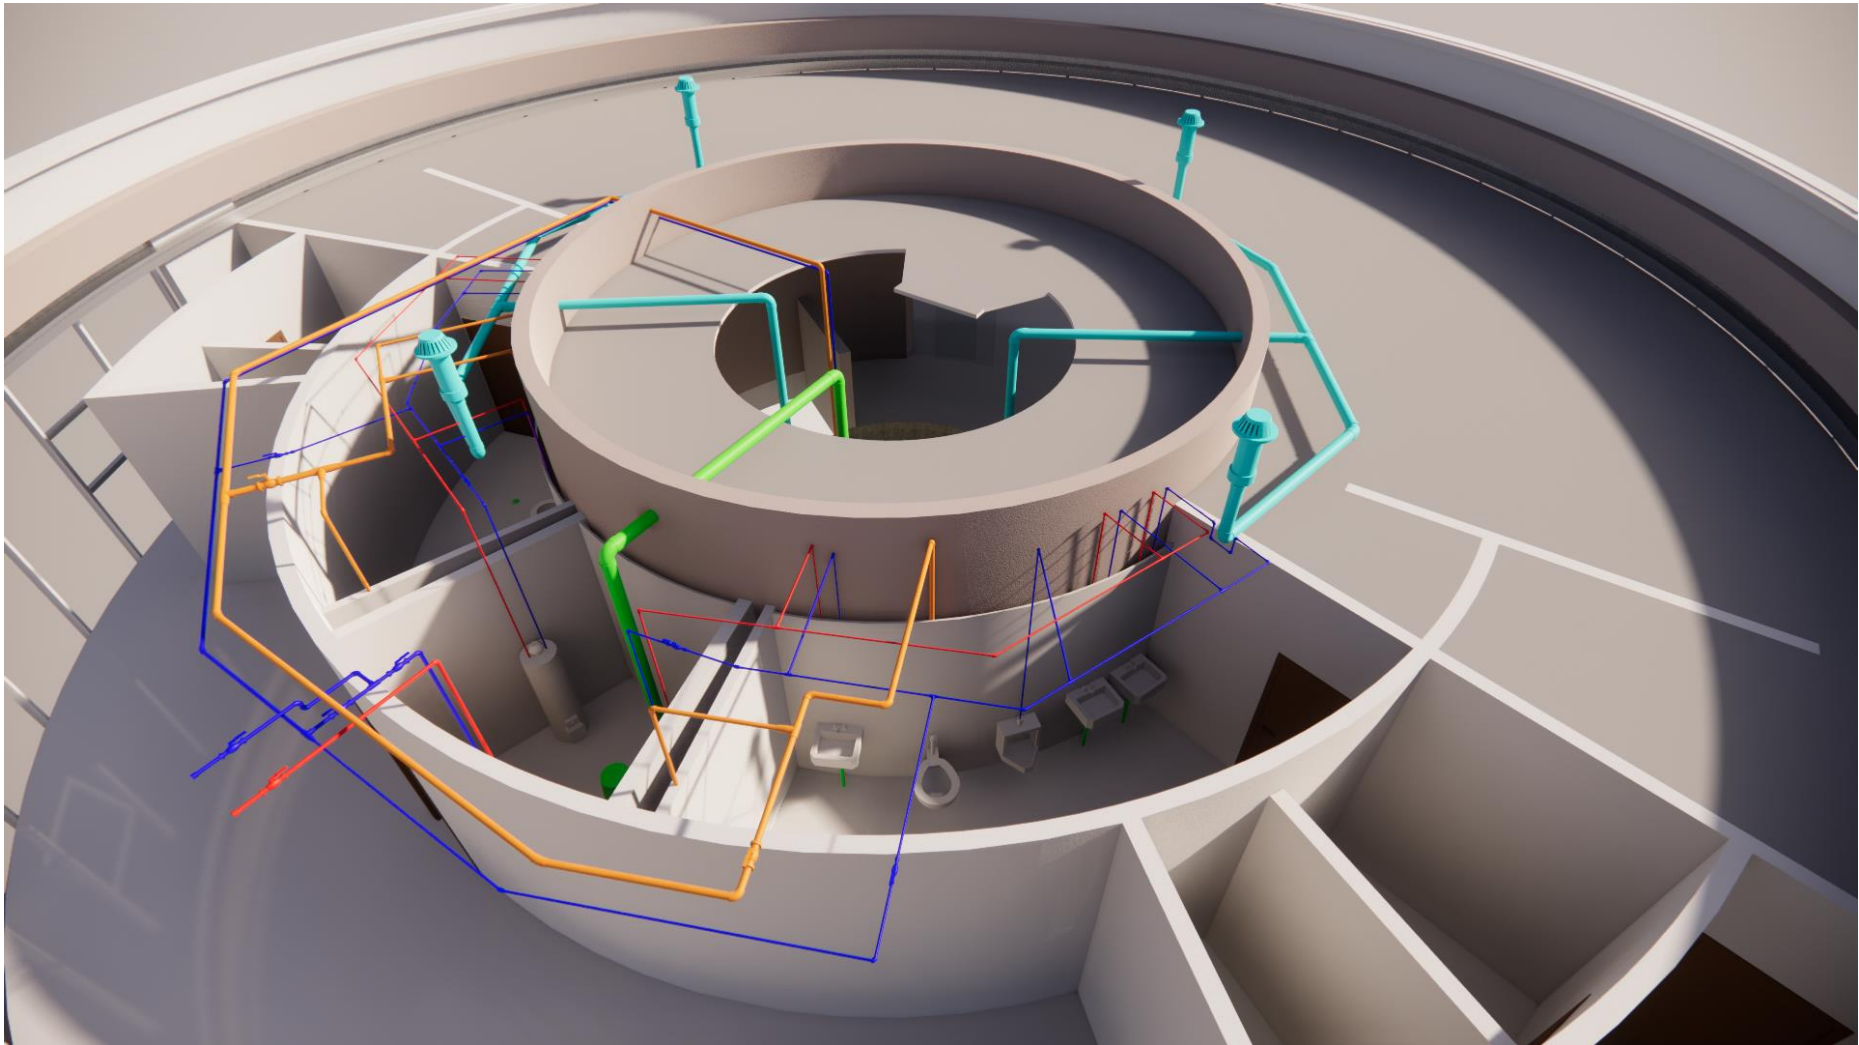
Instalaciones completas de fontanería y saneamiento (renderizado en Enscape)
